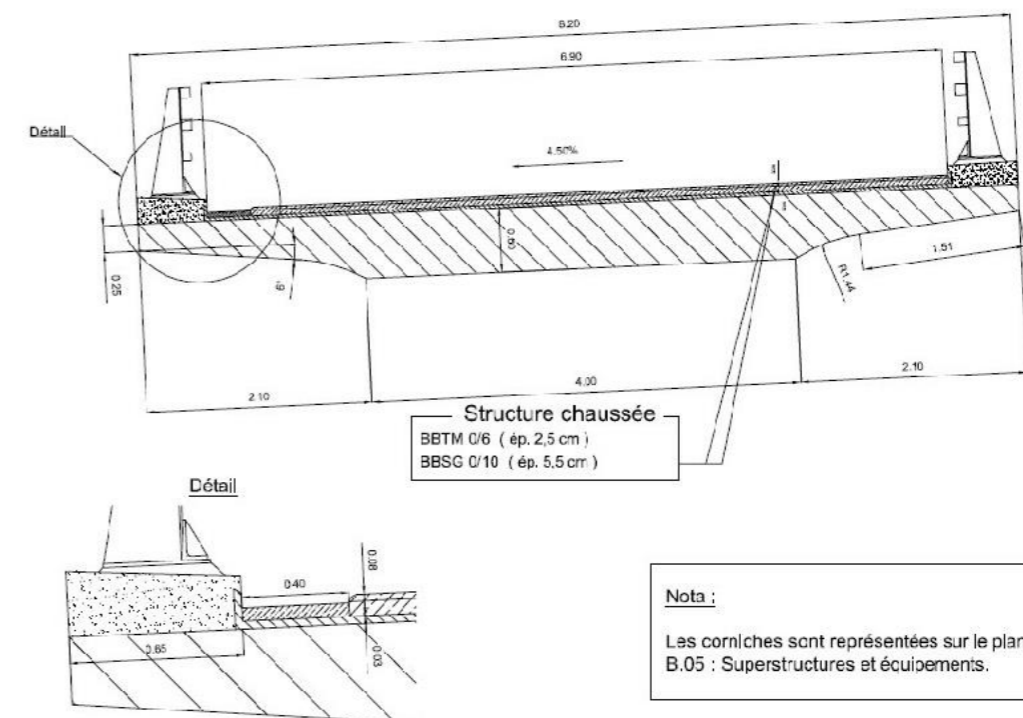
Sezione trasversale della struttura che attraversa il Ca de AVP du Sétra nell'aprile 2008
